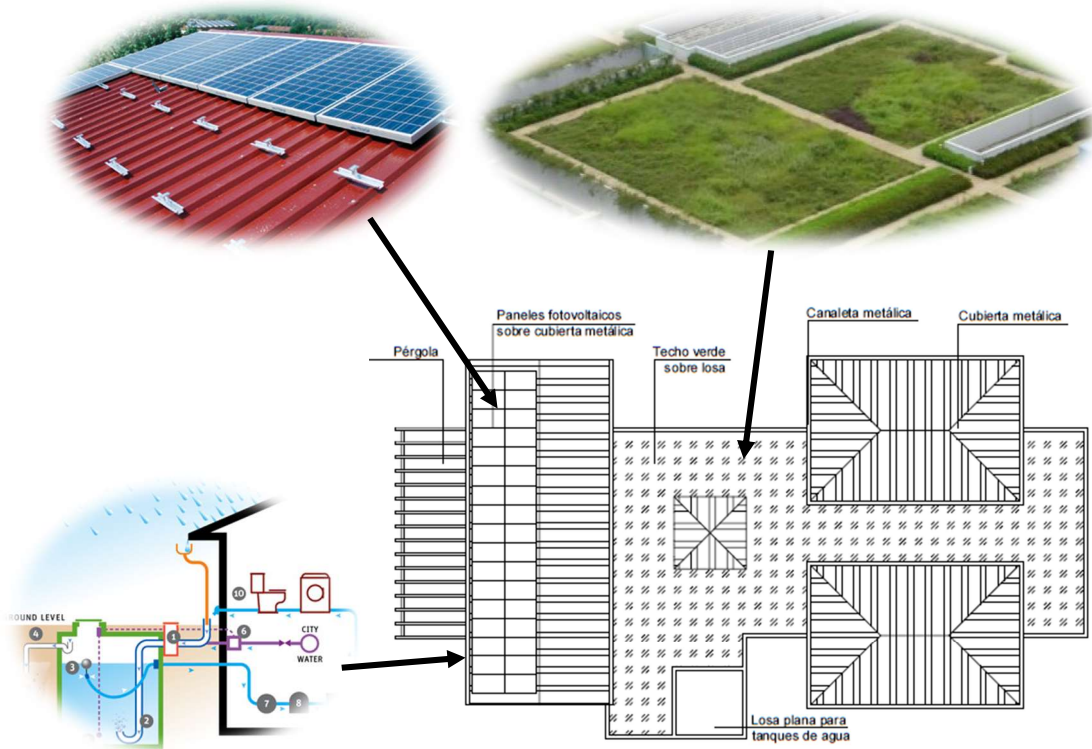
planta de techo del CCM con las modificaciones realizadas en la cubierta del mismo.
